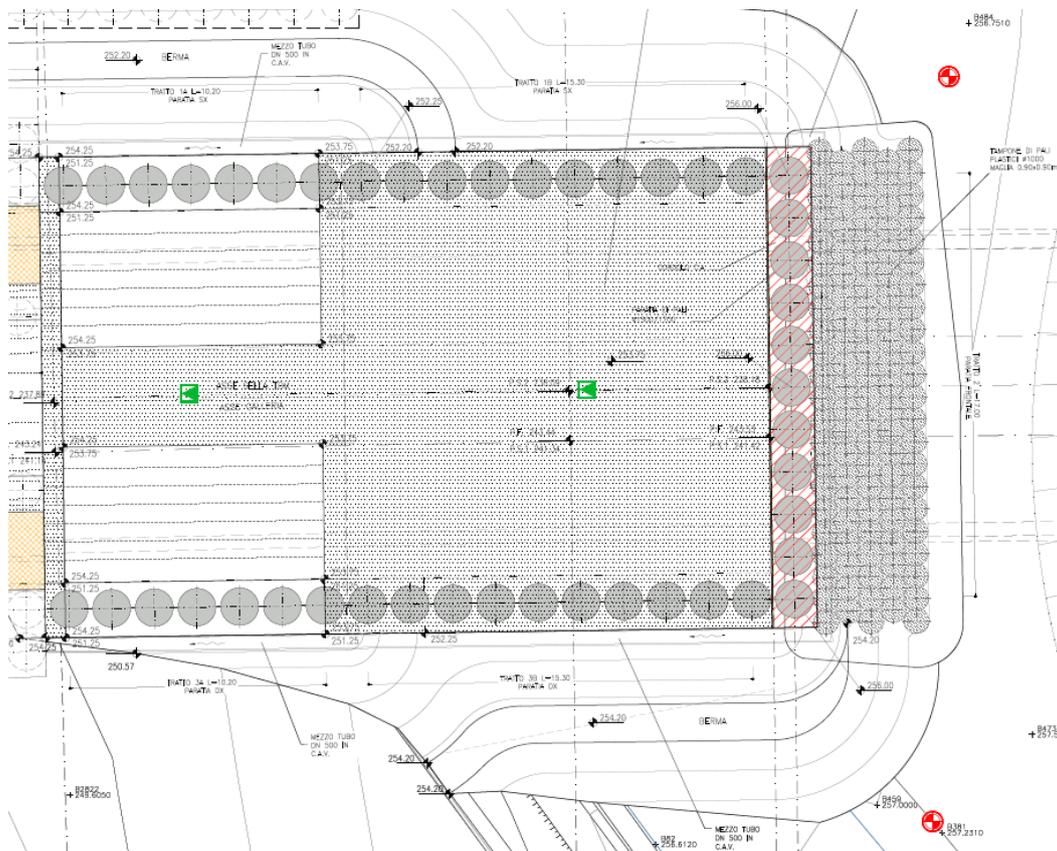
Posizionamento barrette estensimetriche (in verde)
